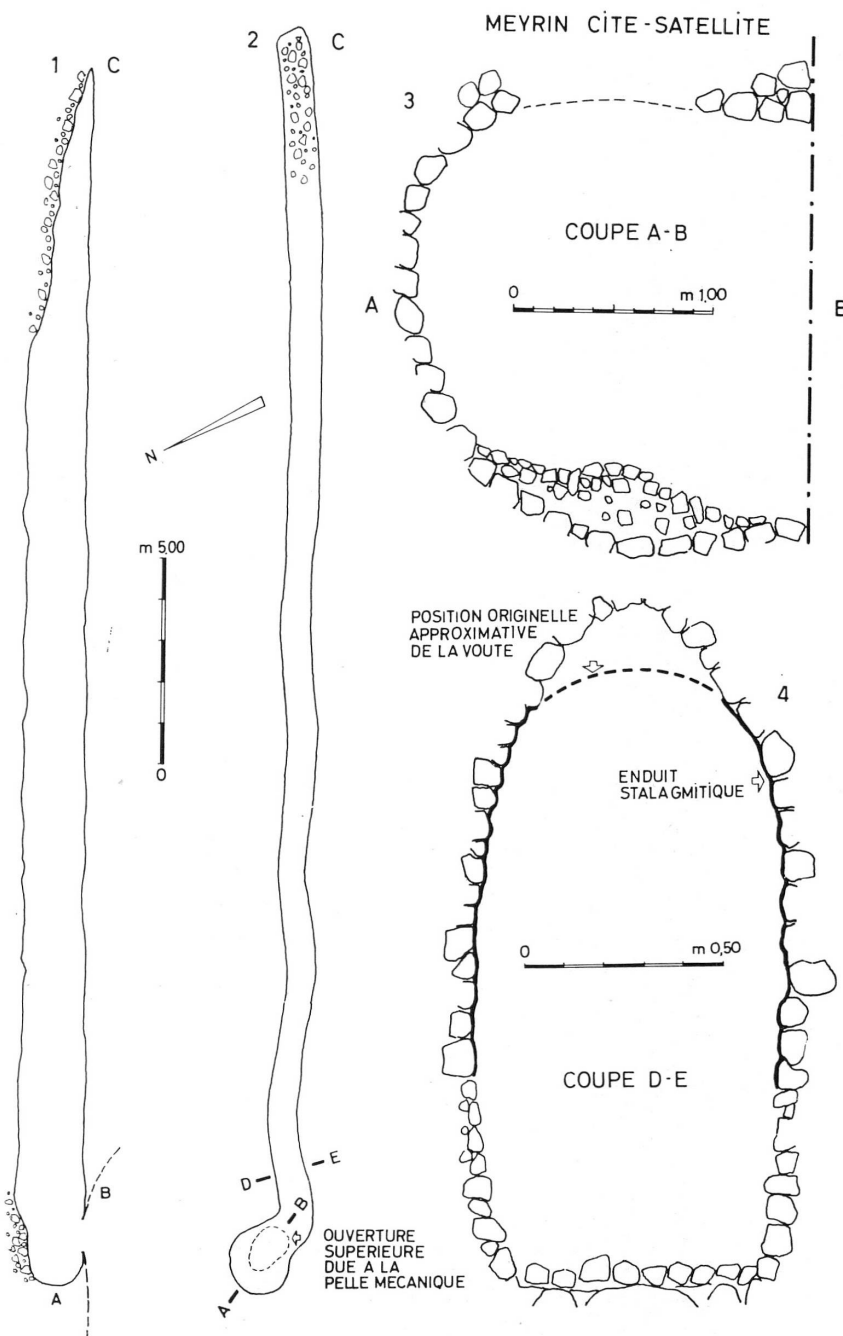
Meyrin. Cité satellite. Galerie II. Coupe longitudinale (1) et plan (2). Ech. 1: 200.
